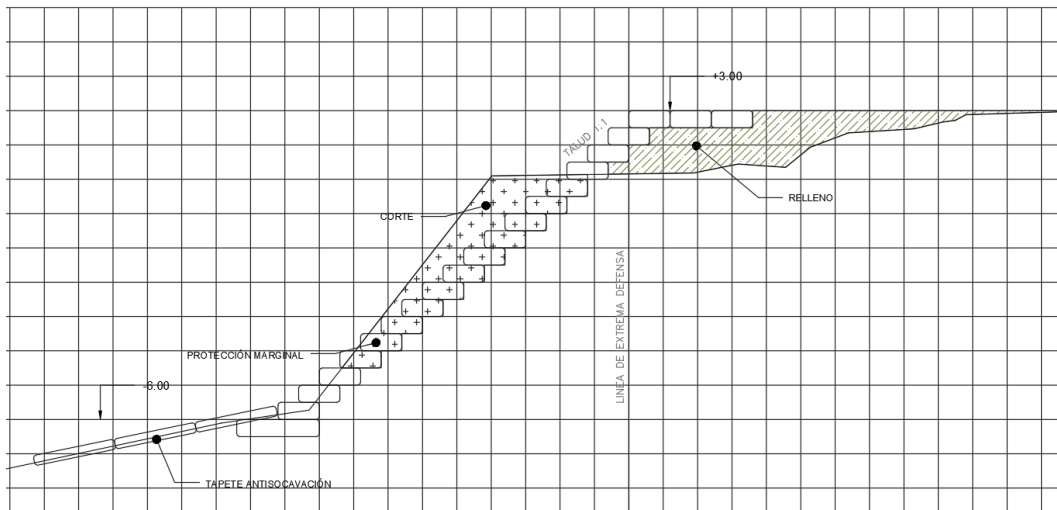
Sección transversal de la protección marginal en el cadenamiento 8+900.
